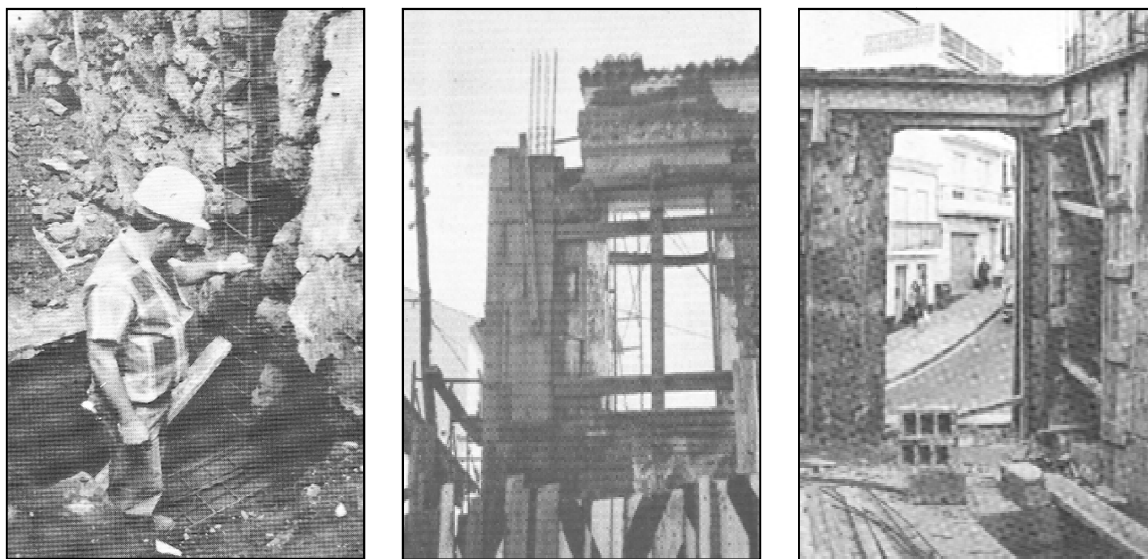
Reconstrução com elementos estruturais em betão armado [23].
